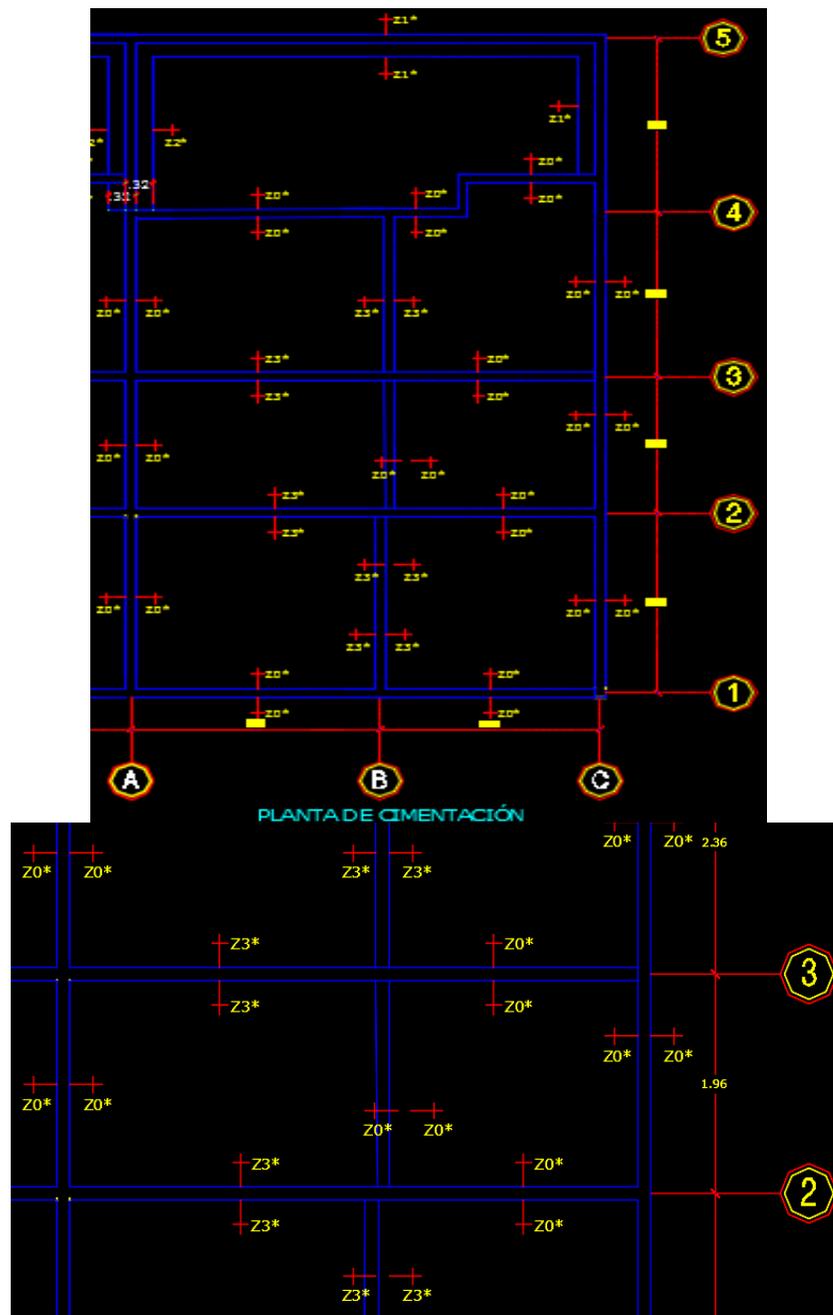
Mala ubicación de acero de refuerzo en losa de cimentación
